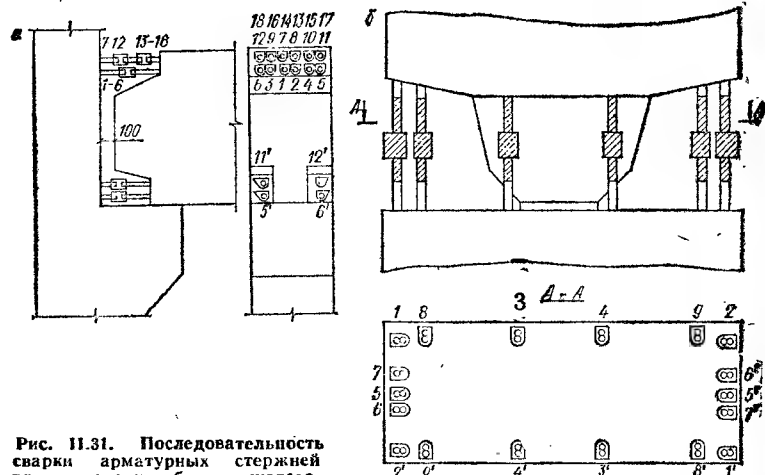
Последовательность сварки арматурных стержней при возведении сборных железобетонных конструкций
